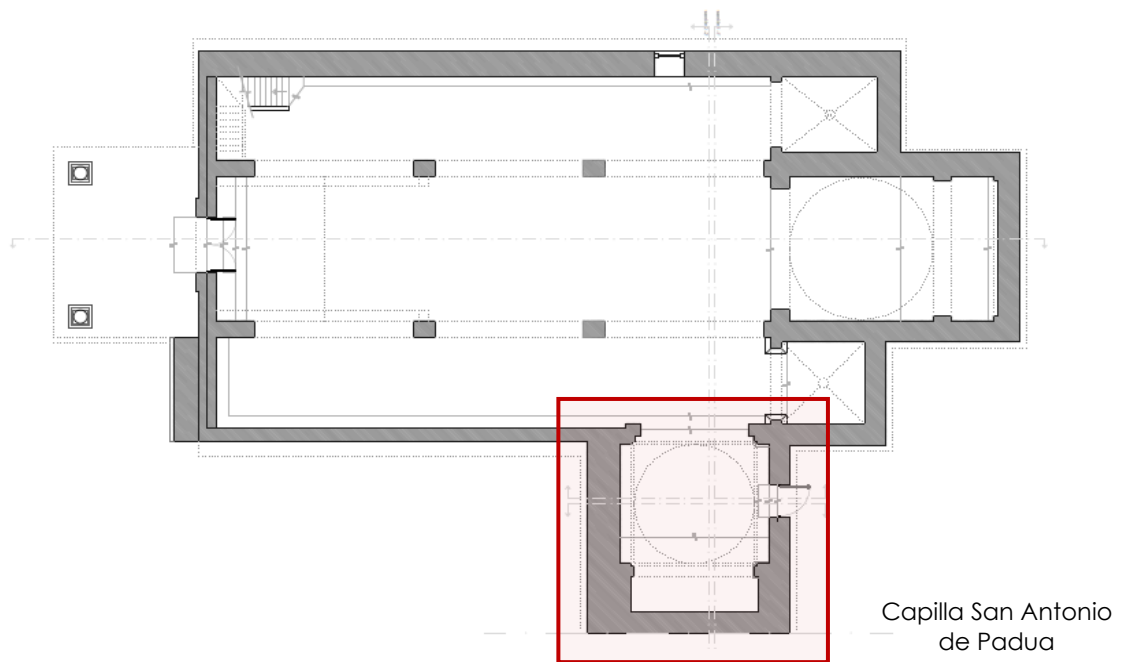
Planta arquitectónica de la ermita de la Virgen de la Huerta. Elaboración propia.
